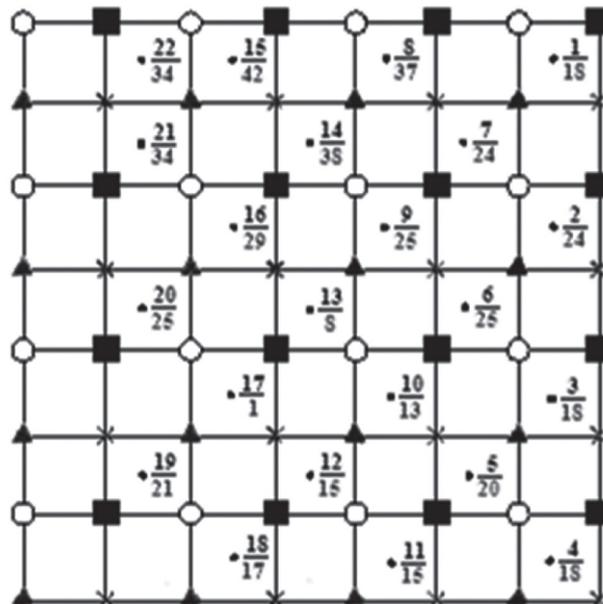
План опытного участка уплотнения грунта основания последовательным взрыванием зарядов
